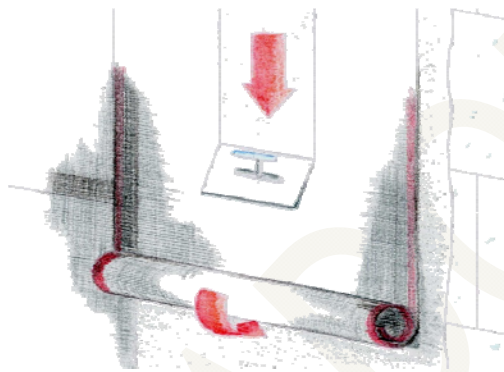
Detalle de la instalación de la malla de armadura sobre la fachada
